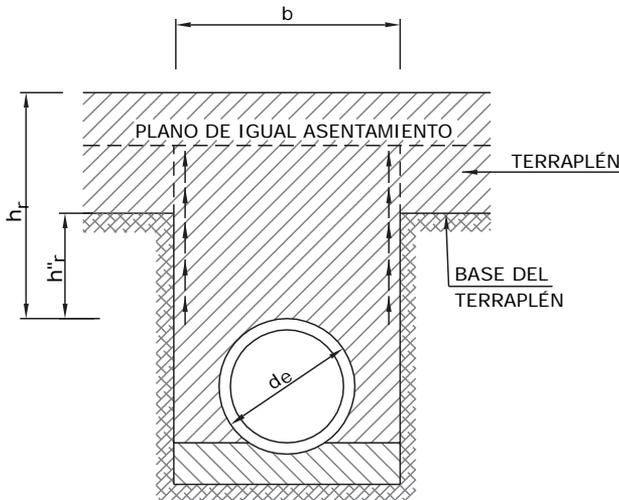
Esquema de tubería colocada en zanja terraplenada.
